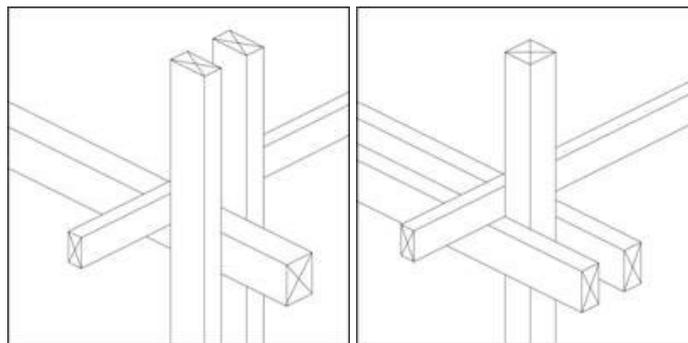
SECTION DE POTEAU (À GAUCHE) OU DE POUTRE (À DROITE) DÉDOUBLÉE [WWW.CNDB.ORG]
